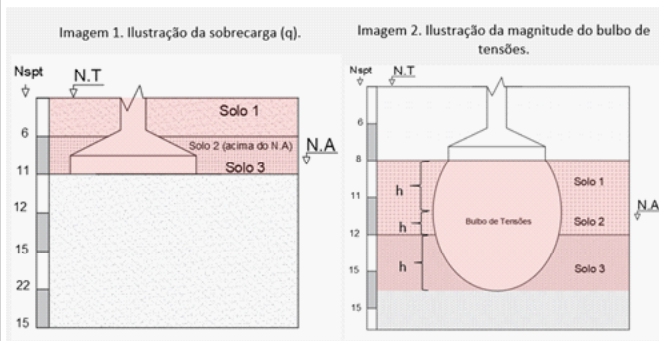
Ilustrações auxiliaadoras no preenchimento da planilha.
